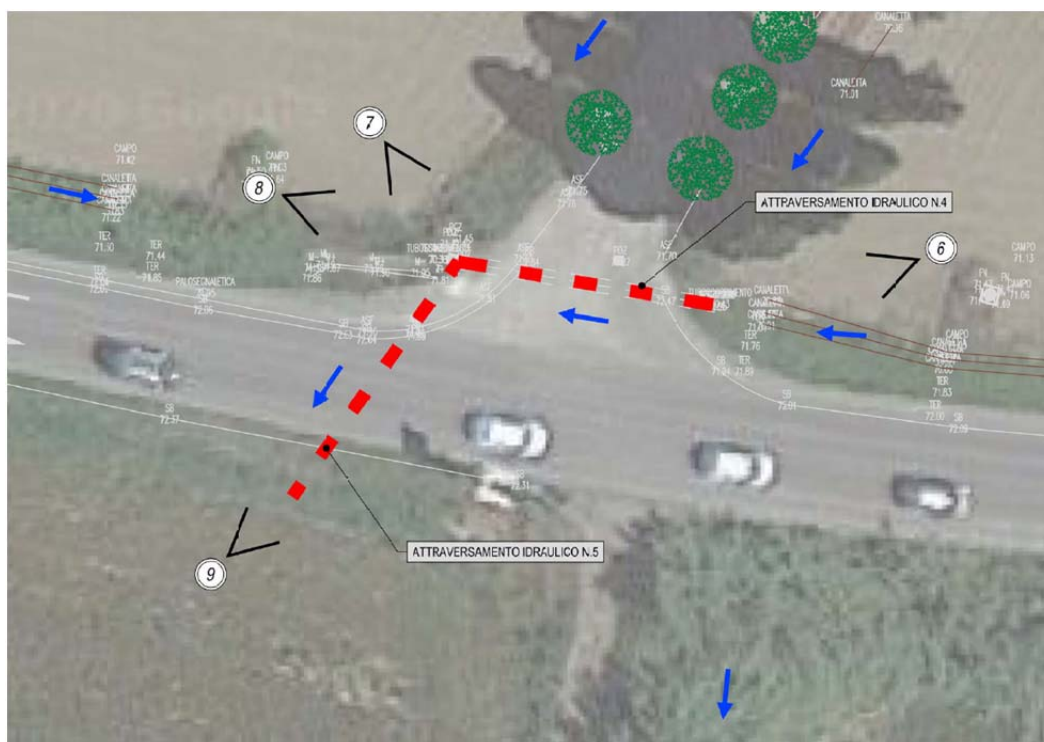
Estratto planimetrico attraversamento n.4 e n.5
